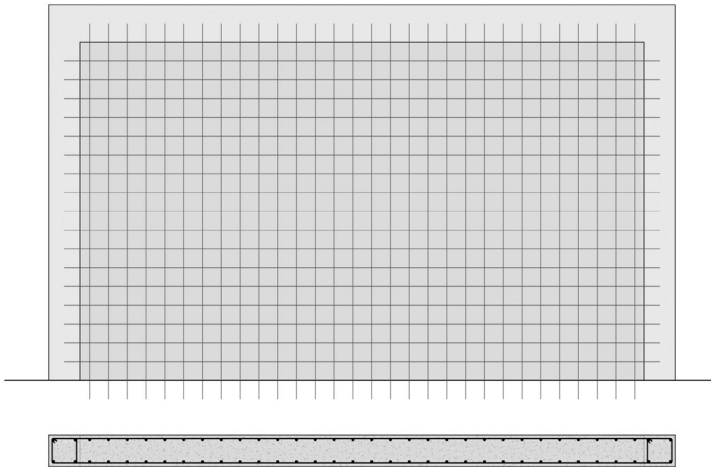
Sistema de rigidización. Pantalla de hormigón armado.
